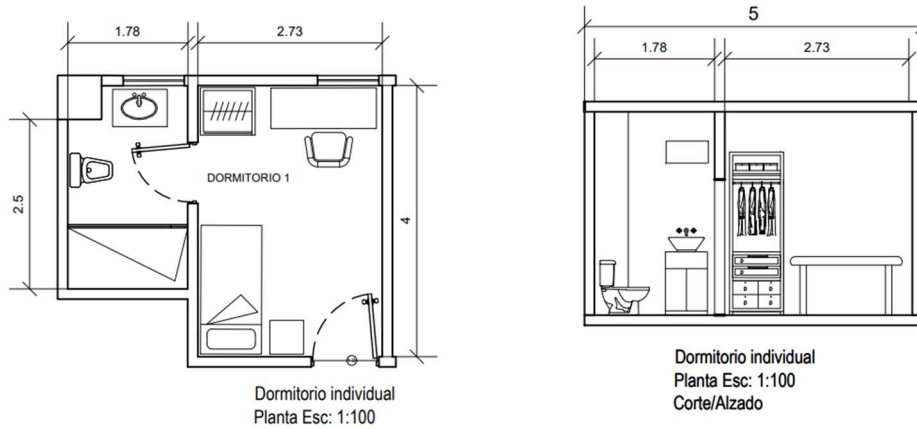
Planta y alzado de dormitorio individual esc. 1:100
